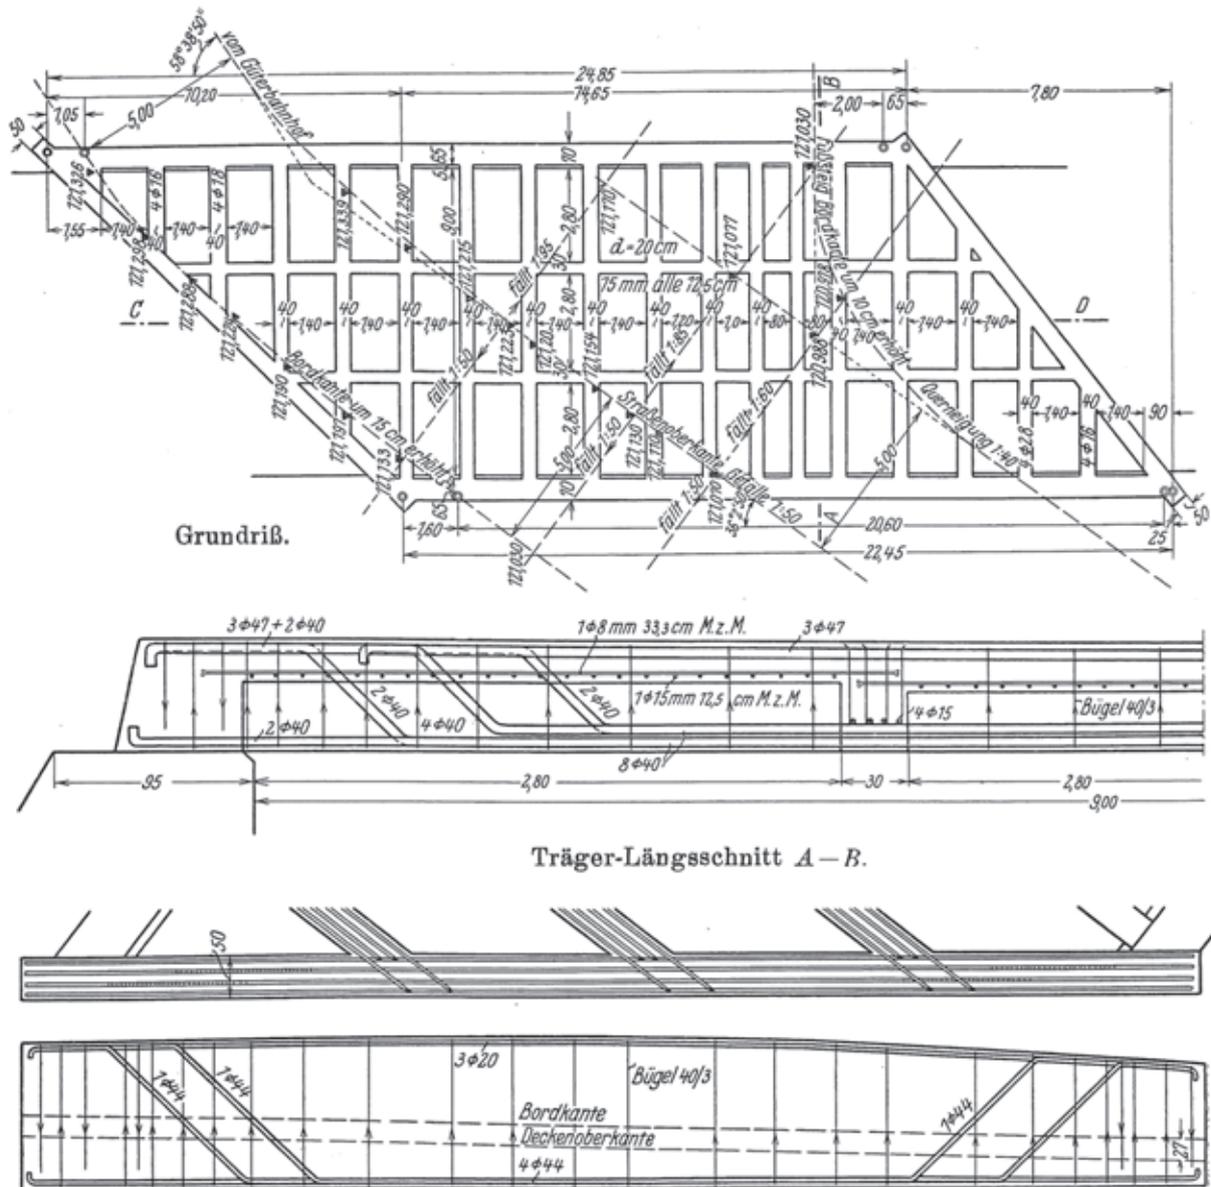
Brücke Güterbahnhof Dresden/Niedersedlitz – Grundriß und Schnitte [10]
